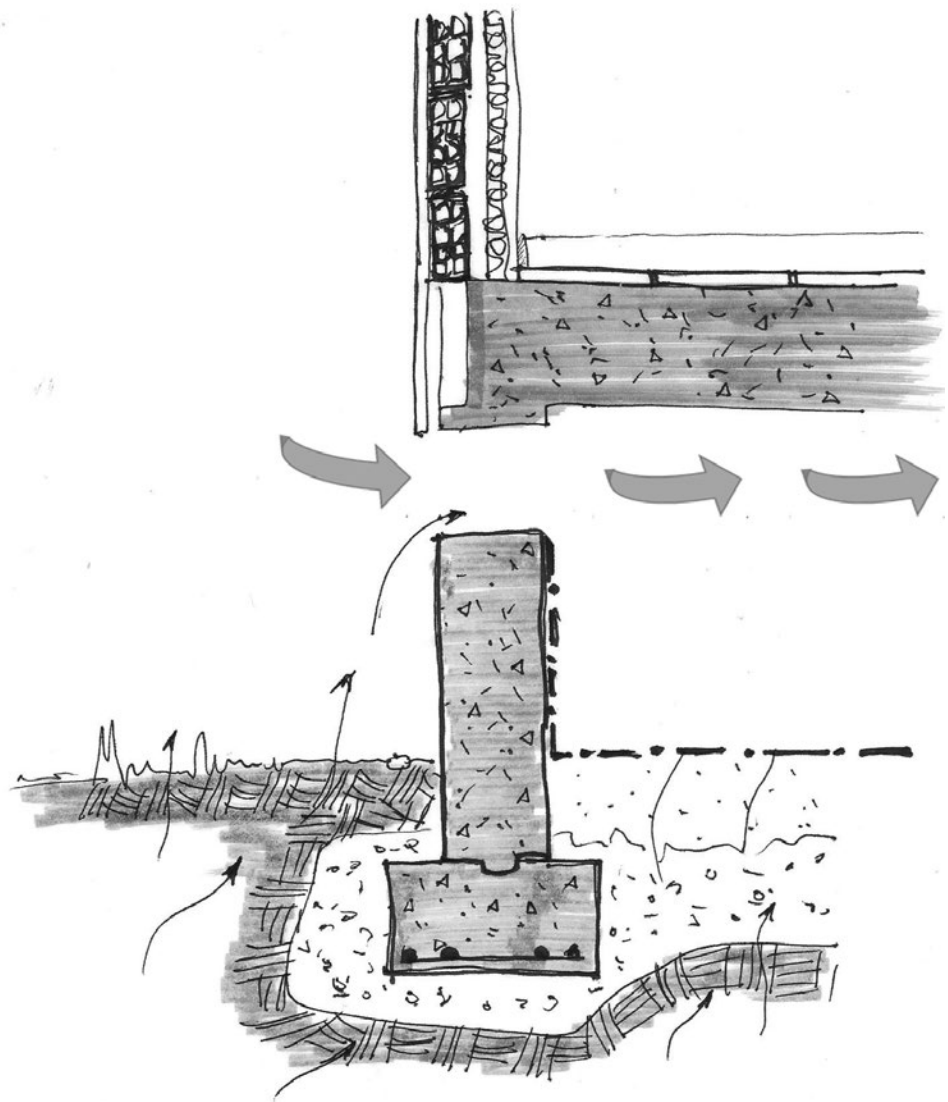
Detalle constructivo de forjado sanitario ventilado.
